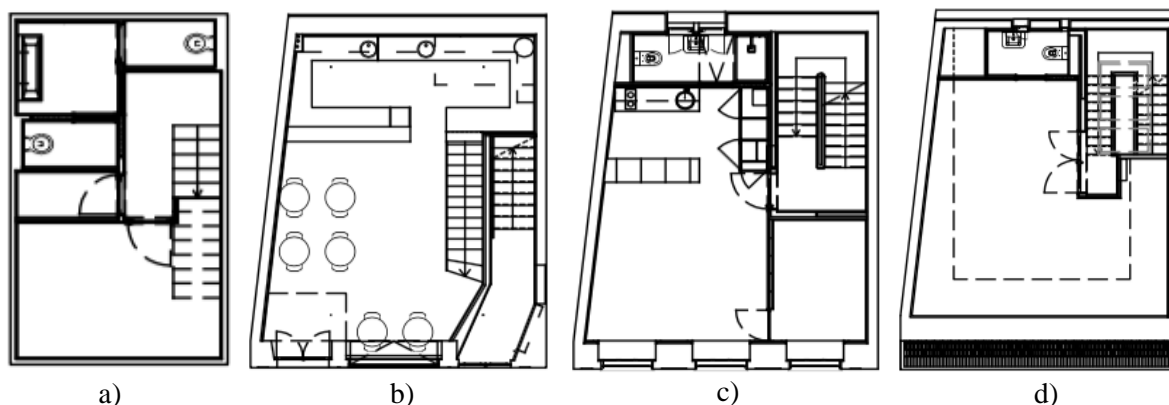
Plantas CAD do caso de estudo após a intervenção. a) Planta da cave; b) planta do R/C; c) planta dos andares de habitação; d) planta das águas furtadas.
